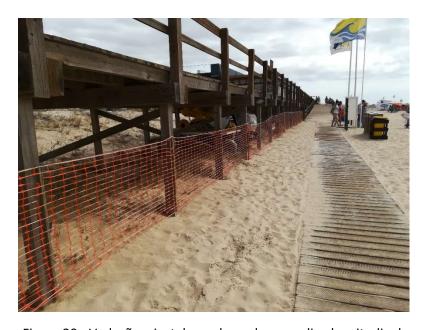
Vedação a instalar na base do passadiço longitudinal.
